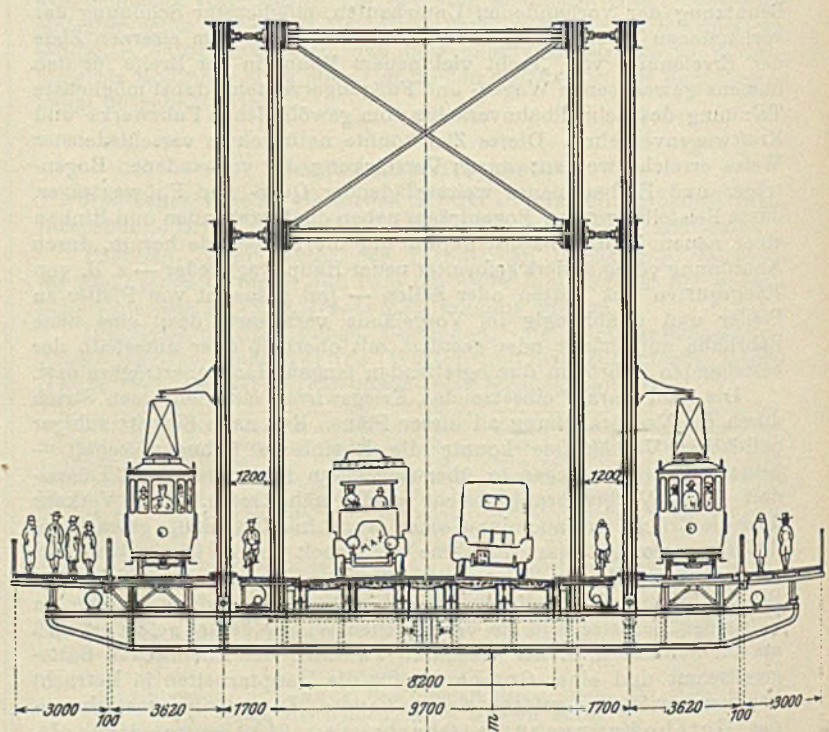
Querschnitt mit eng gestellten Hauptträgern.
